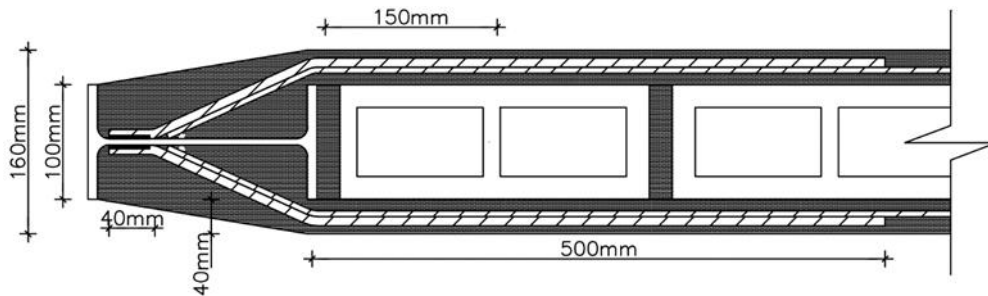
Esquema en planta de conexión entre columnas y enchape del prototipo II
